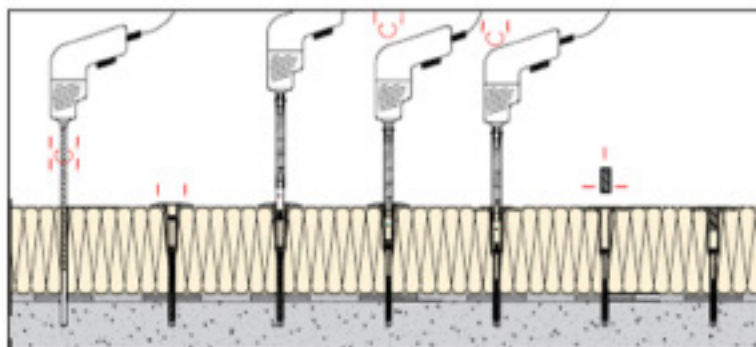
Colocación aislamiento con fijación ejotherm STR U 2G
